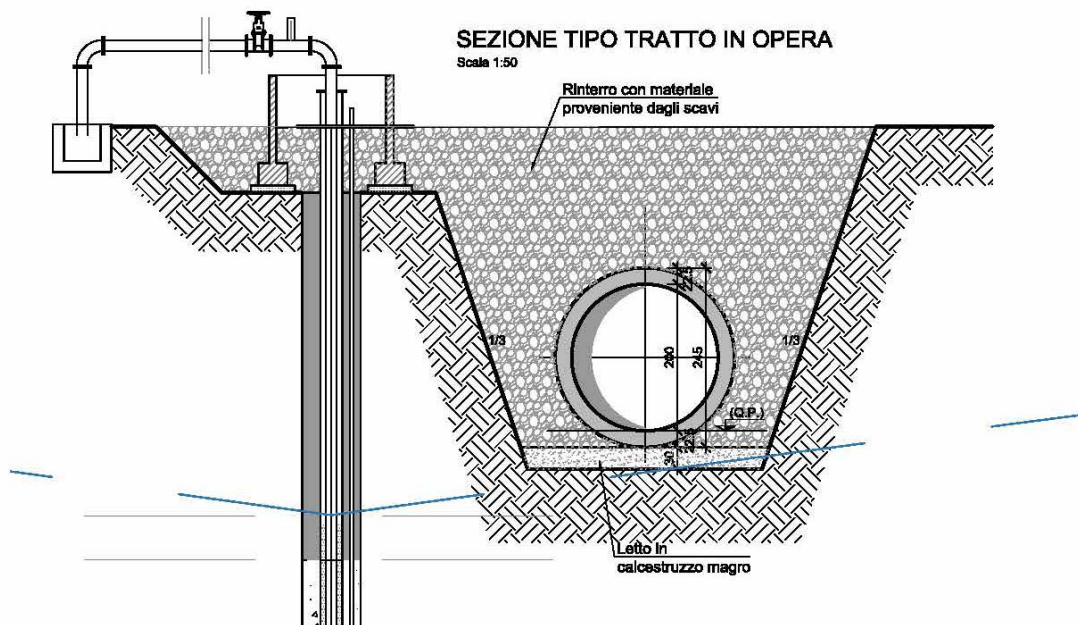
Opera IN08 - Sezione Trasversale tratto C-D
